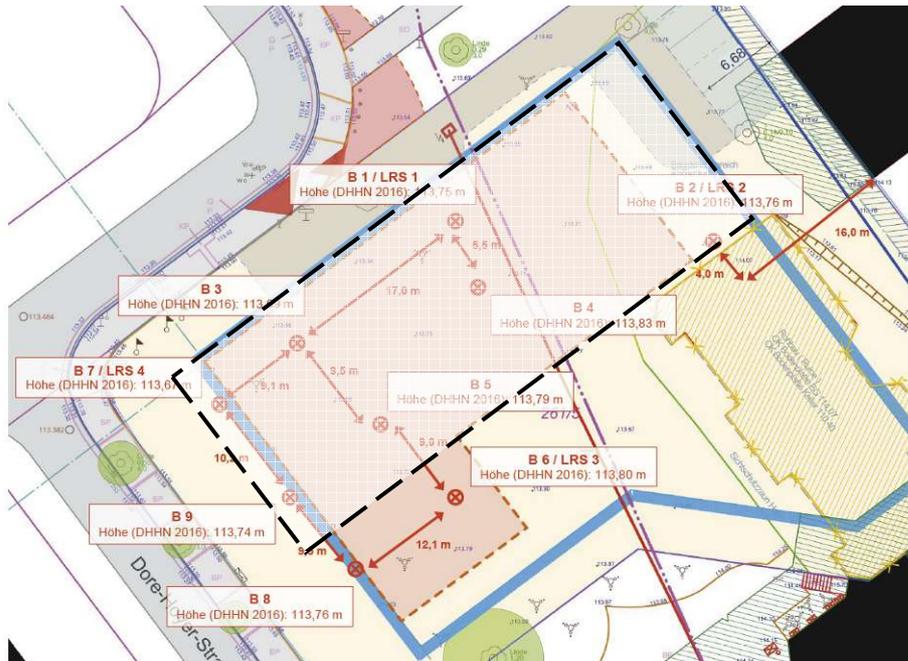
Übersicht Baugrundaufschlüsse und Lage Neubau ([3])
